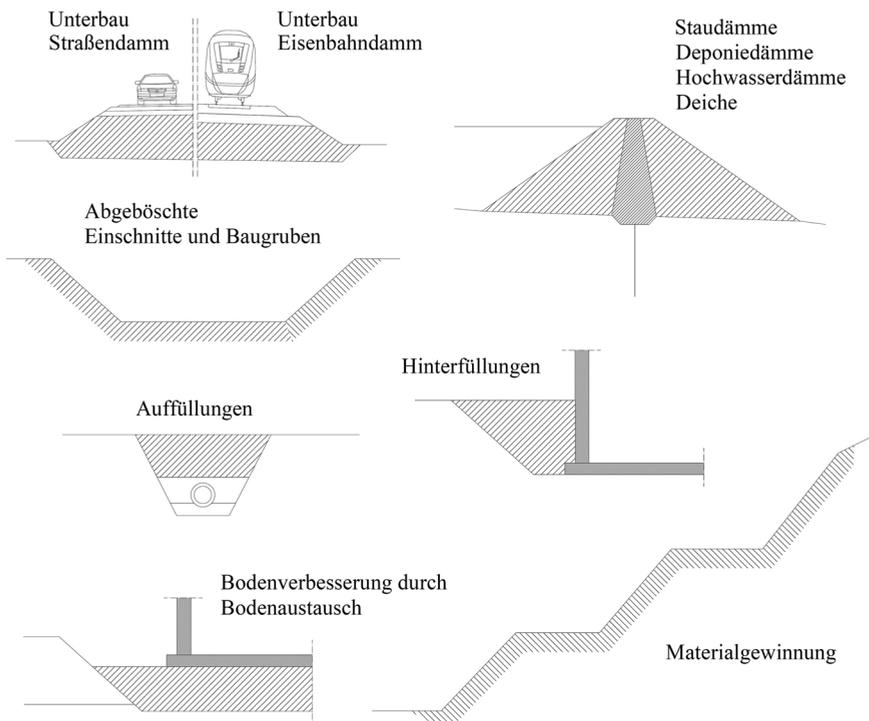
Anwendungsbereiche und Abgrenzung des Erdbaus (nach [29])
